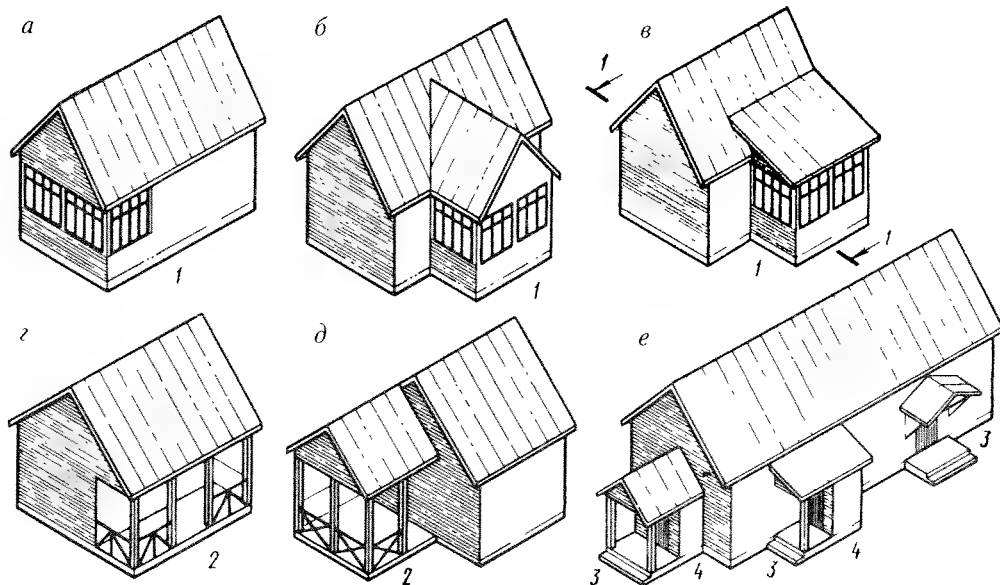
Летние приквартирные помещения малоэтажных жилых зданий:
